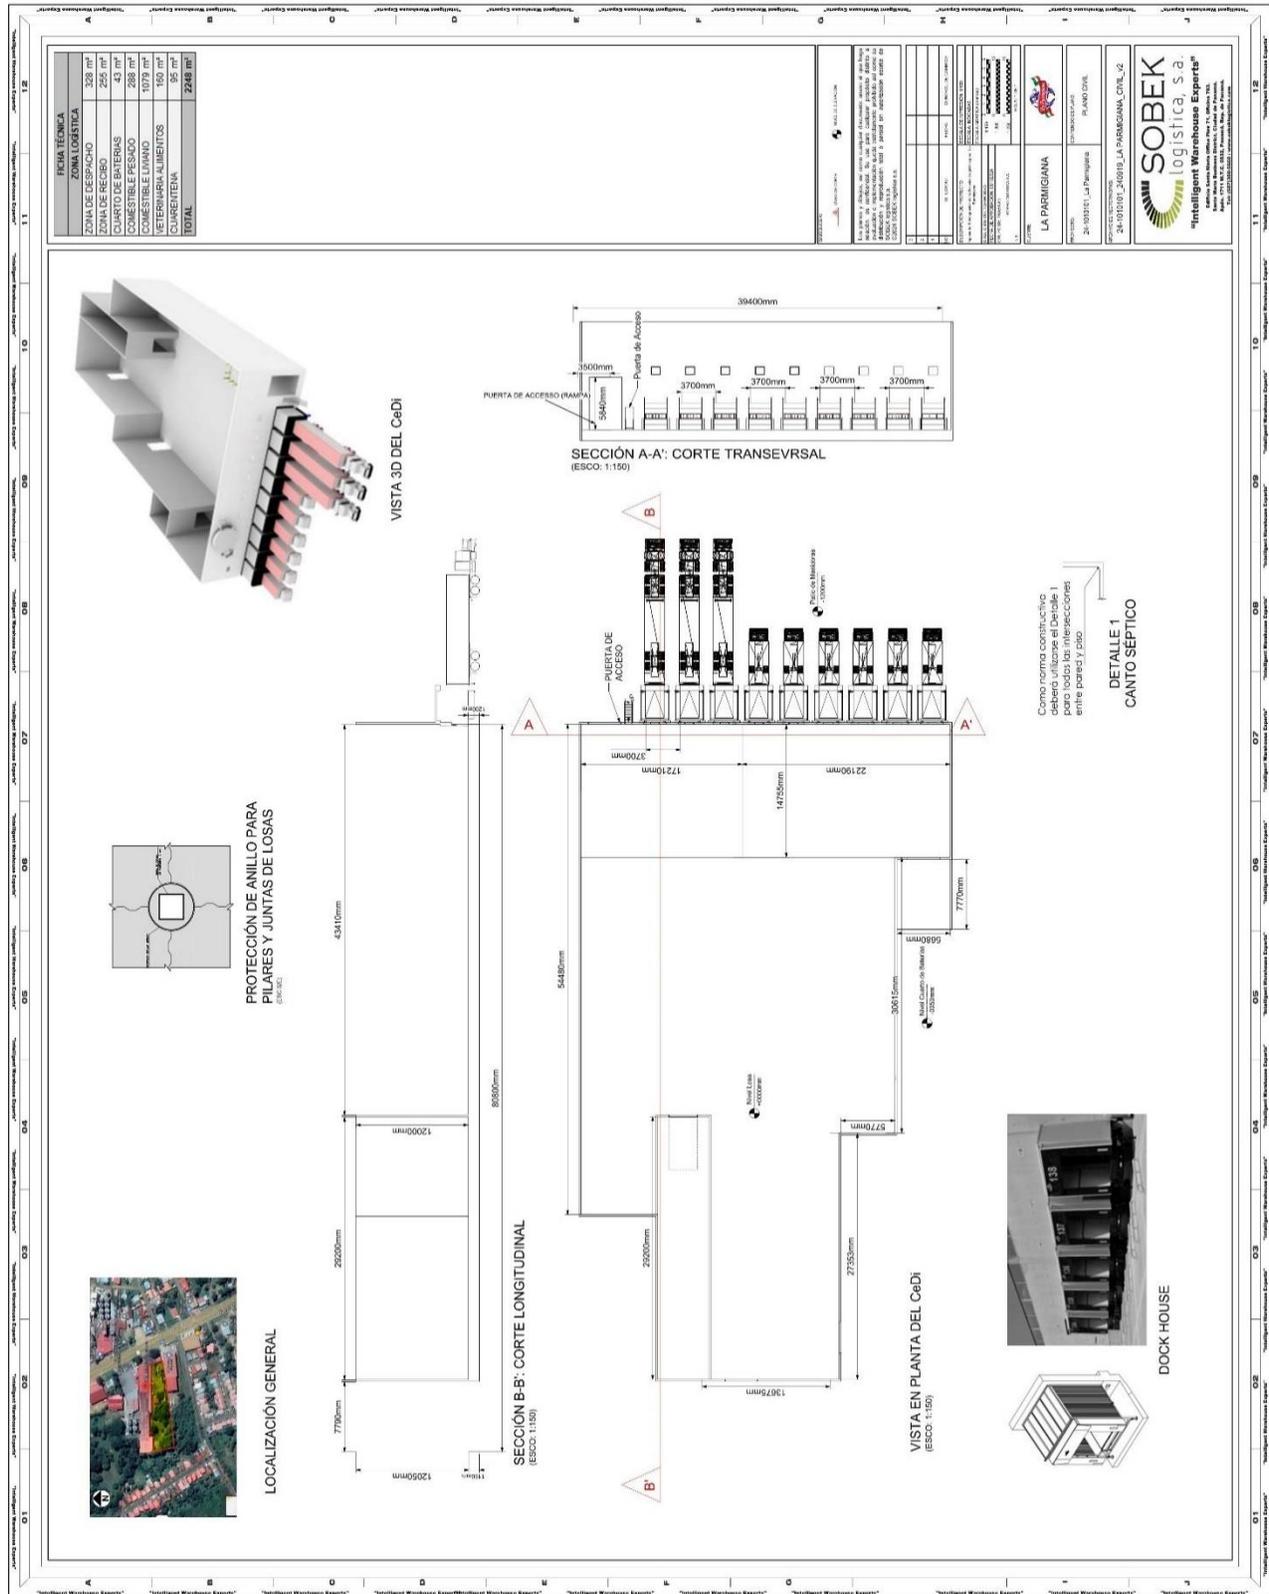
Planta arquitectónica de la bodega de producto terminado (secciones internas).
